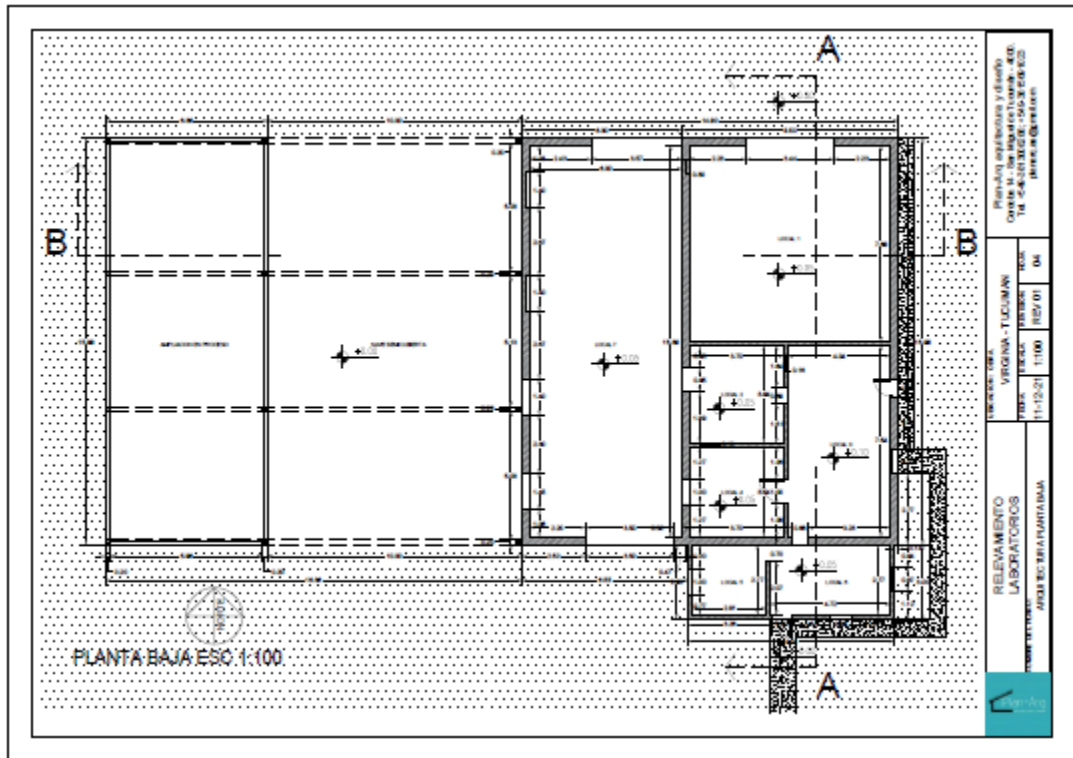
Plano propuesto para el armado del laboratorio de extracción de cannabinoides.
